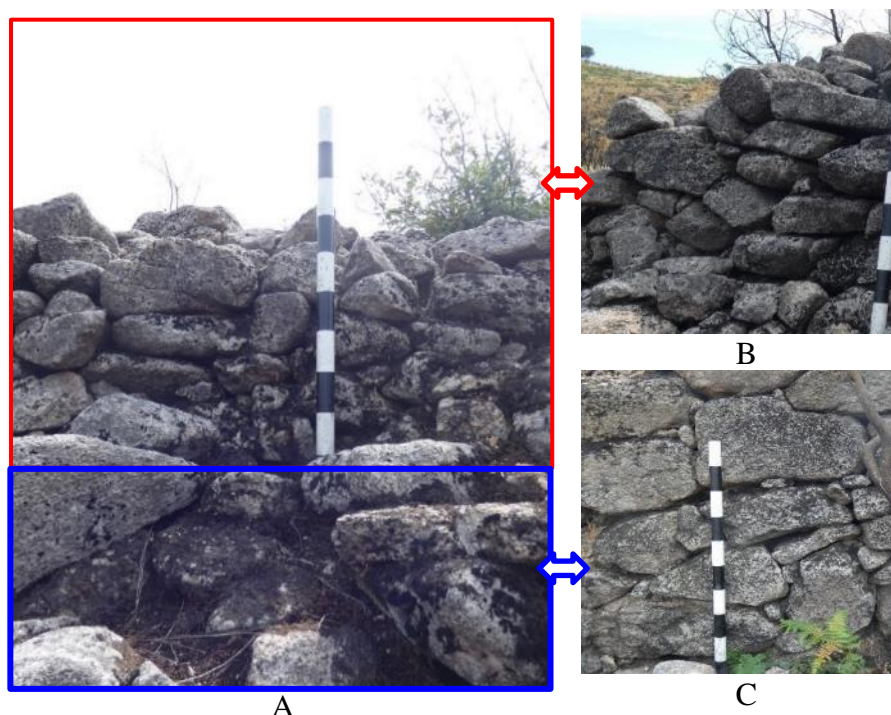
Castro de Vila Cova-à-Coelheira. A. Vista da muralha principal em cima (vermelho) e reforço (azul). B. Pormenor muralha. C. Pormenor do reforço externo
